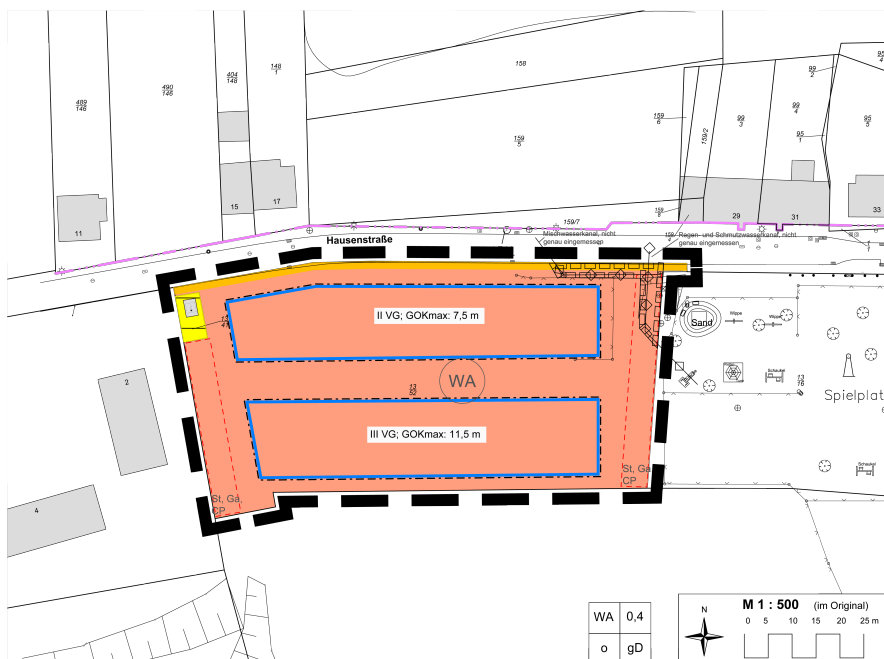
Bebauungsplan VI/31 „Wohnpark Hausenstraße“ /2/
